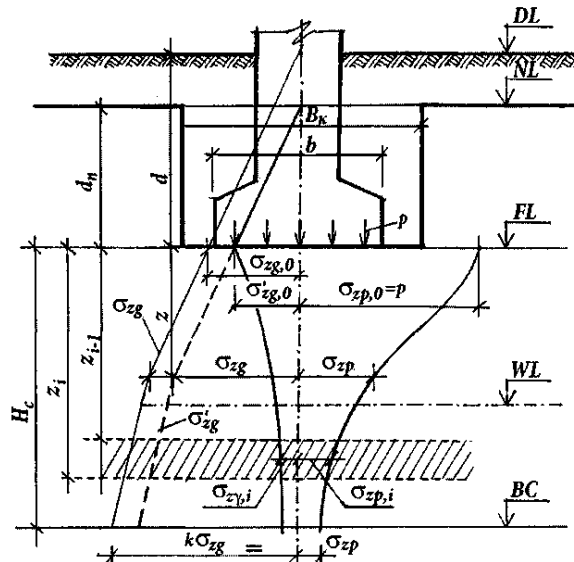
Схема розрахунку осадок фундаменту методом пошарового підсумовування для схеми лінійно-деформованого півпростору
